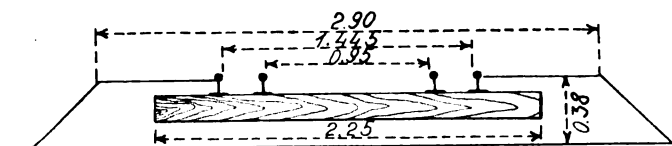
Disposizione del doppio binario. - Elevazione.
